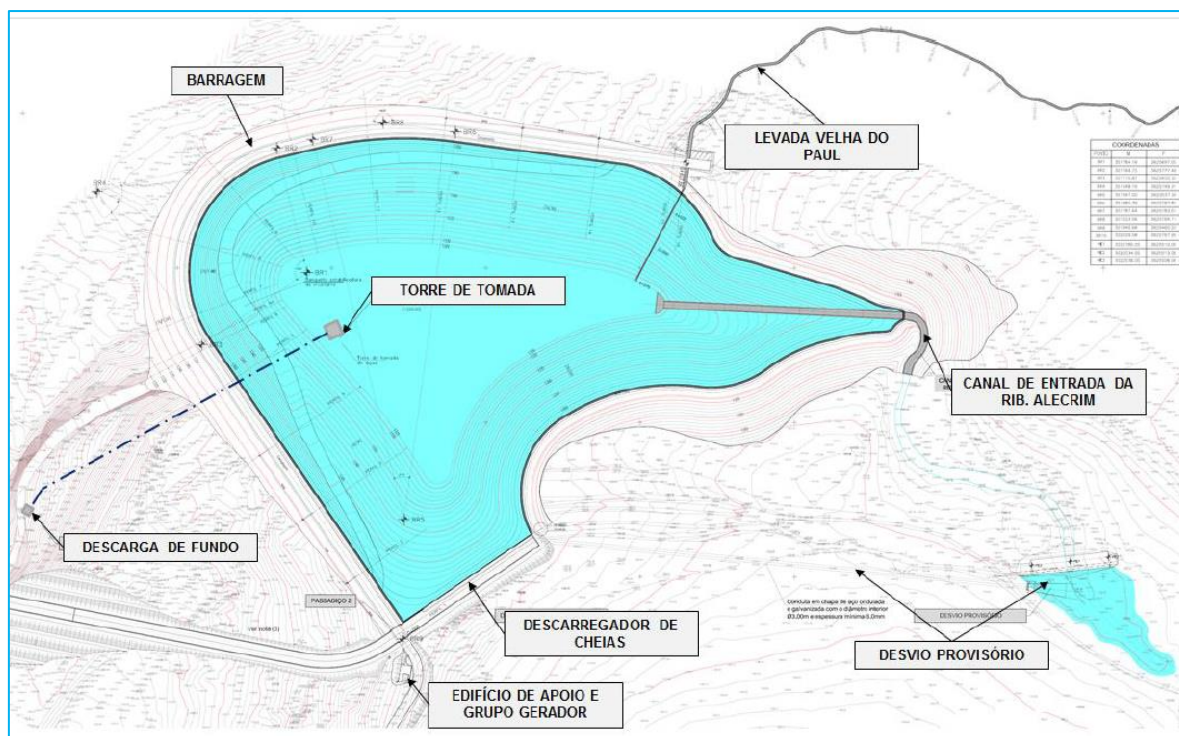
Planta de implantação da barragem do Pico da Urze, órgãos principais
